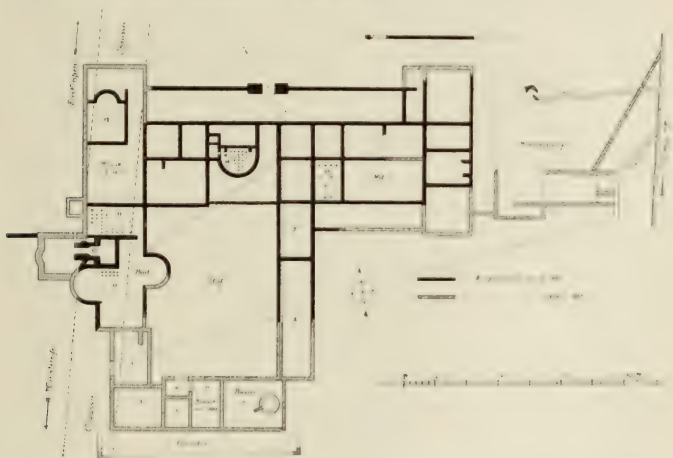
Weingarten. Grundriss der römischen Villa
